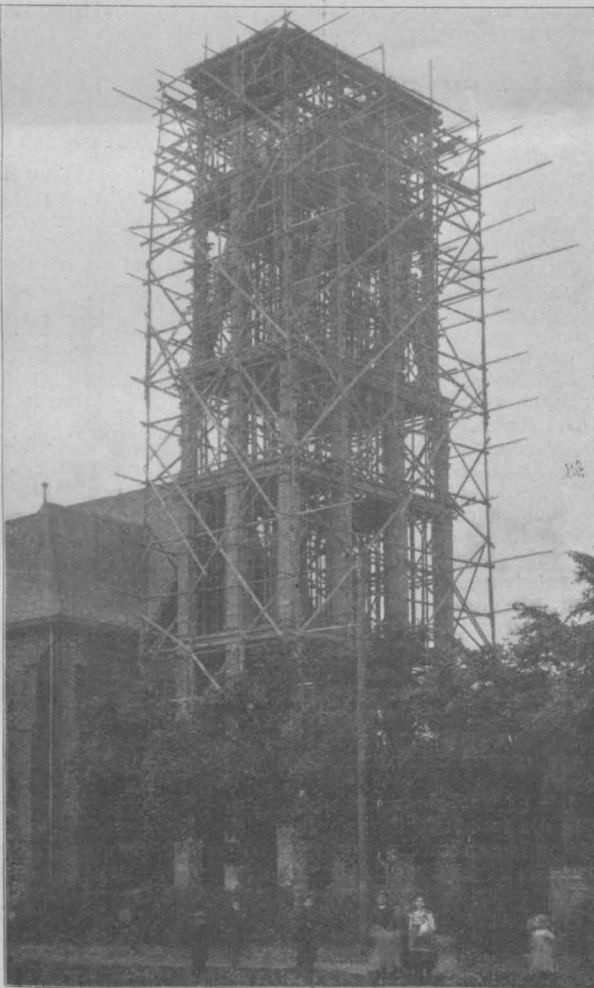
und 2. Eisenbeton-Fachwerk des Turmes der Liebfrauen-Kirche in Hamm i. W.
